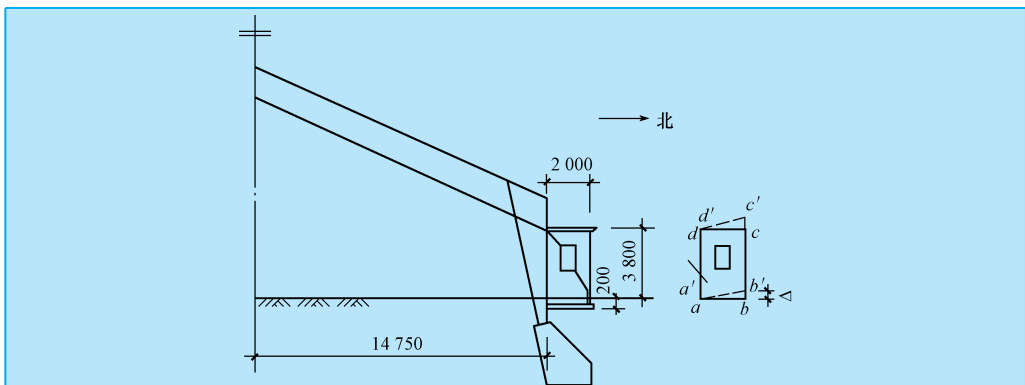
某饭厅门斗墙体开裂示意图 (单位: mm)
